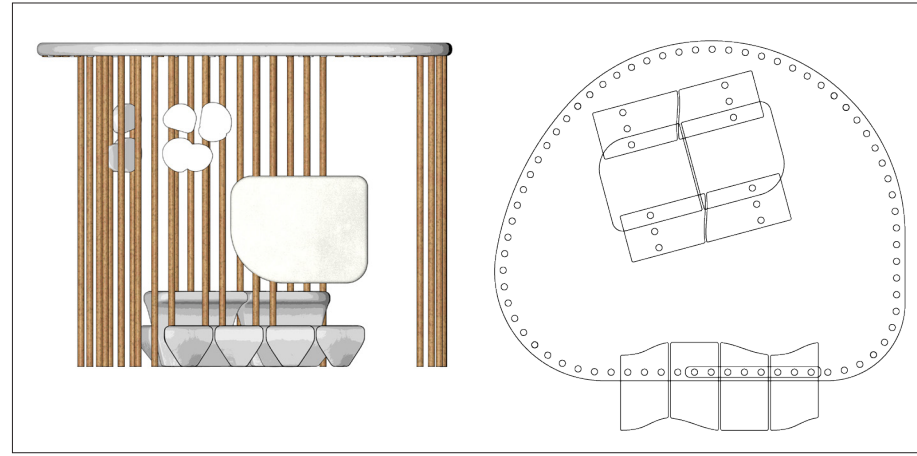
Alzado y planta de la propuesta que ocupa 14m².
